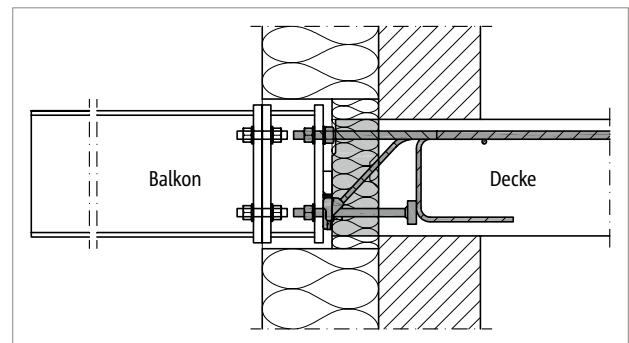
Schöck Isokorb® T Typ SKP: Anschluss des Stahlträgers an einen Adapter, der die Dicke der Aussendämmung ausgleicht
